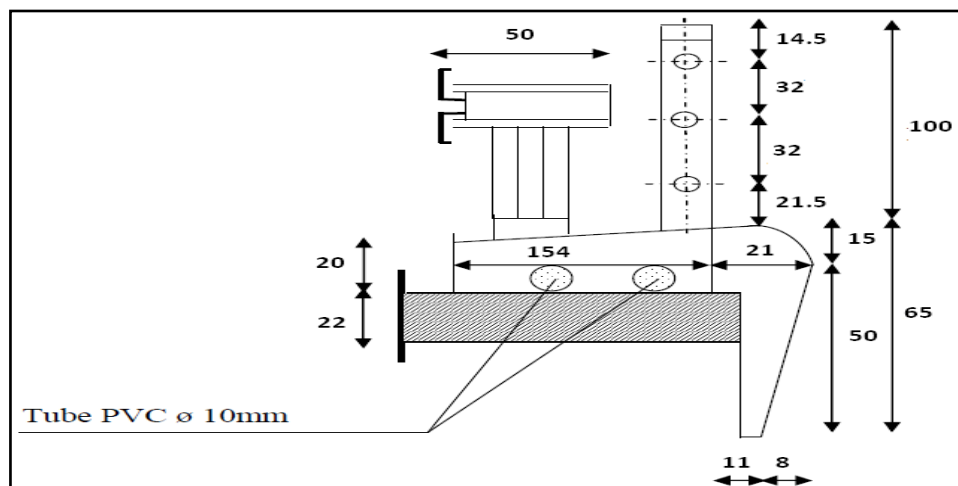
Coupe transversale d'un trottoir (avec éléments non porteurs)
